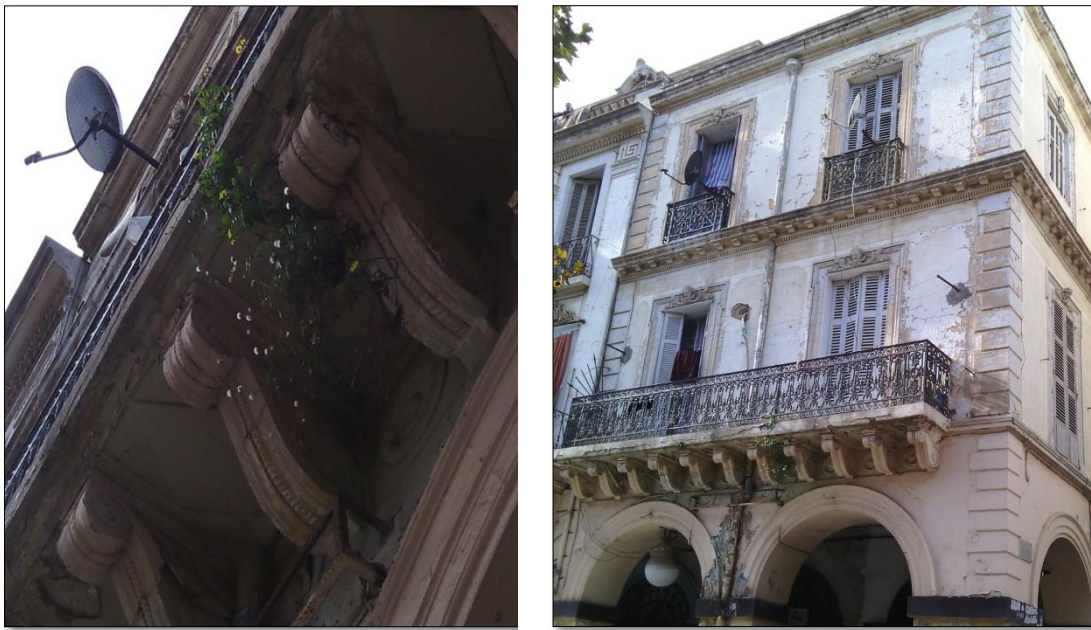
/ 109 : végétation et vieillissement et écaillage de enduits de façade
